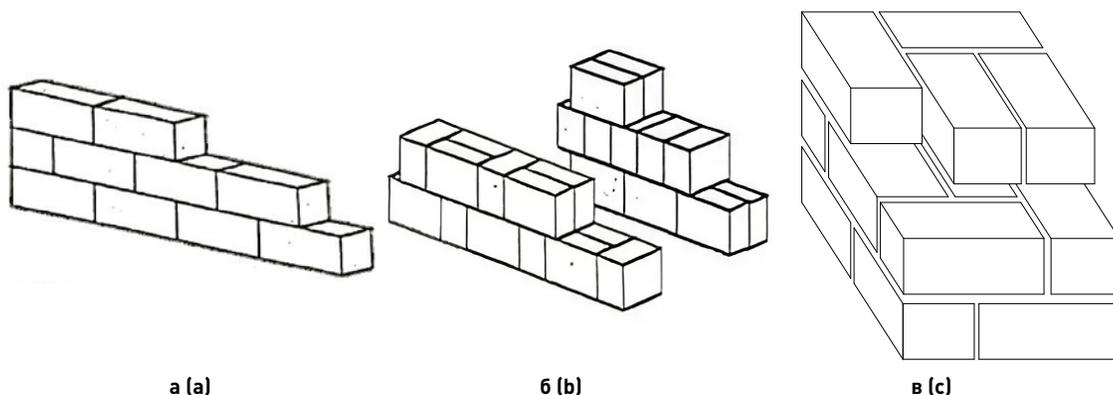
Схемы кладки в соответствии с нормами Великобритании и России: а – кладка без продольного шва – с перевязкой только в продольном направлении; б – кладка с продольным швом и поперечной перевязкой; в – кладка столба
